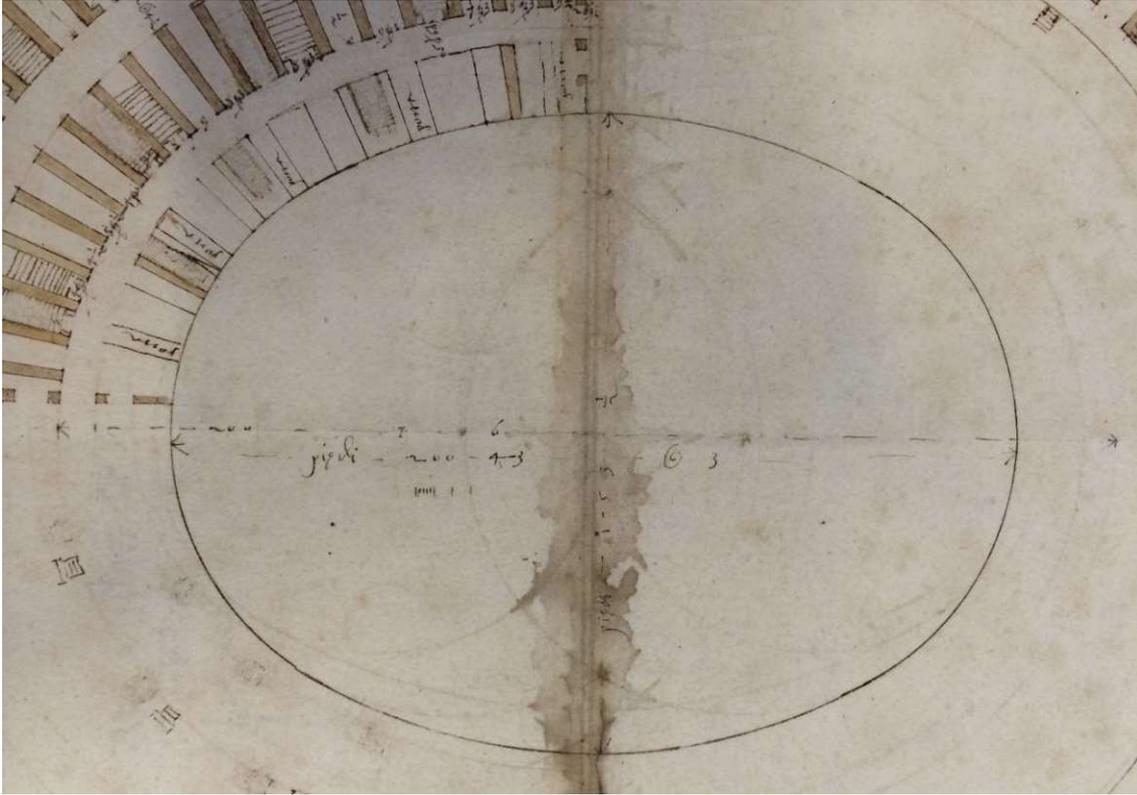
Detailausschnitt aus Palladios Konstruktionsweise des Kolosseums (London, Royal Institute of British Architects (RIBA), Palladio Collection, VIII/15 recto)
